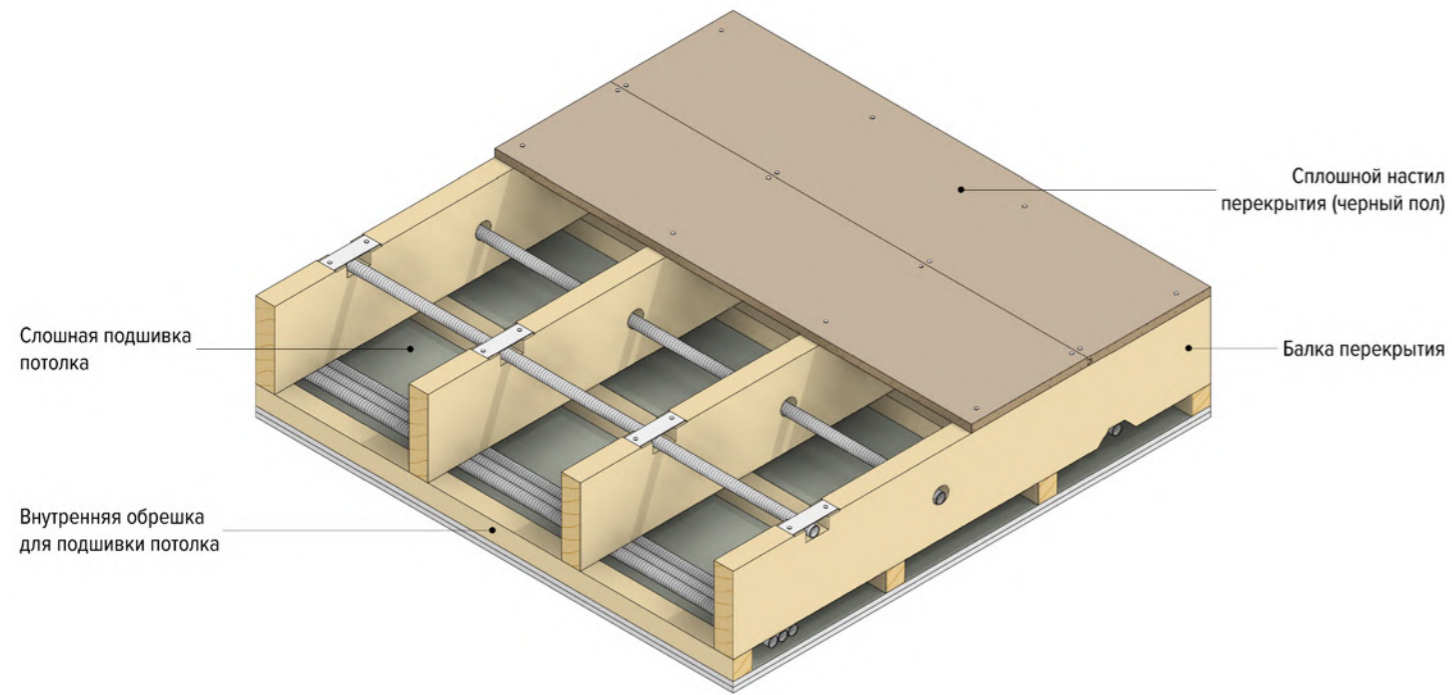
Основные конструктивные слои каркаса межэтажного перекрытия
